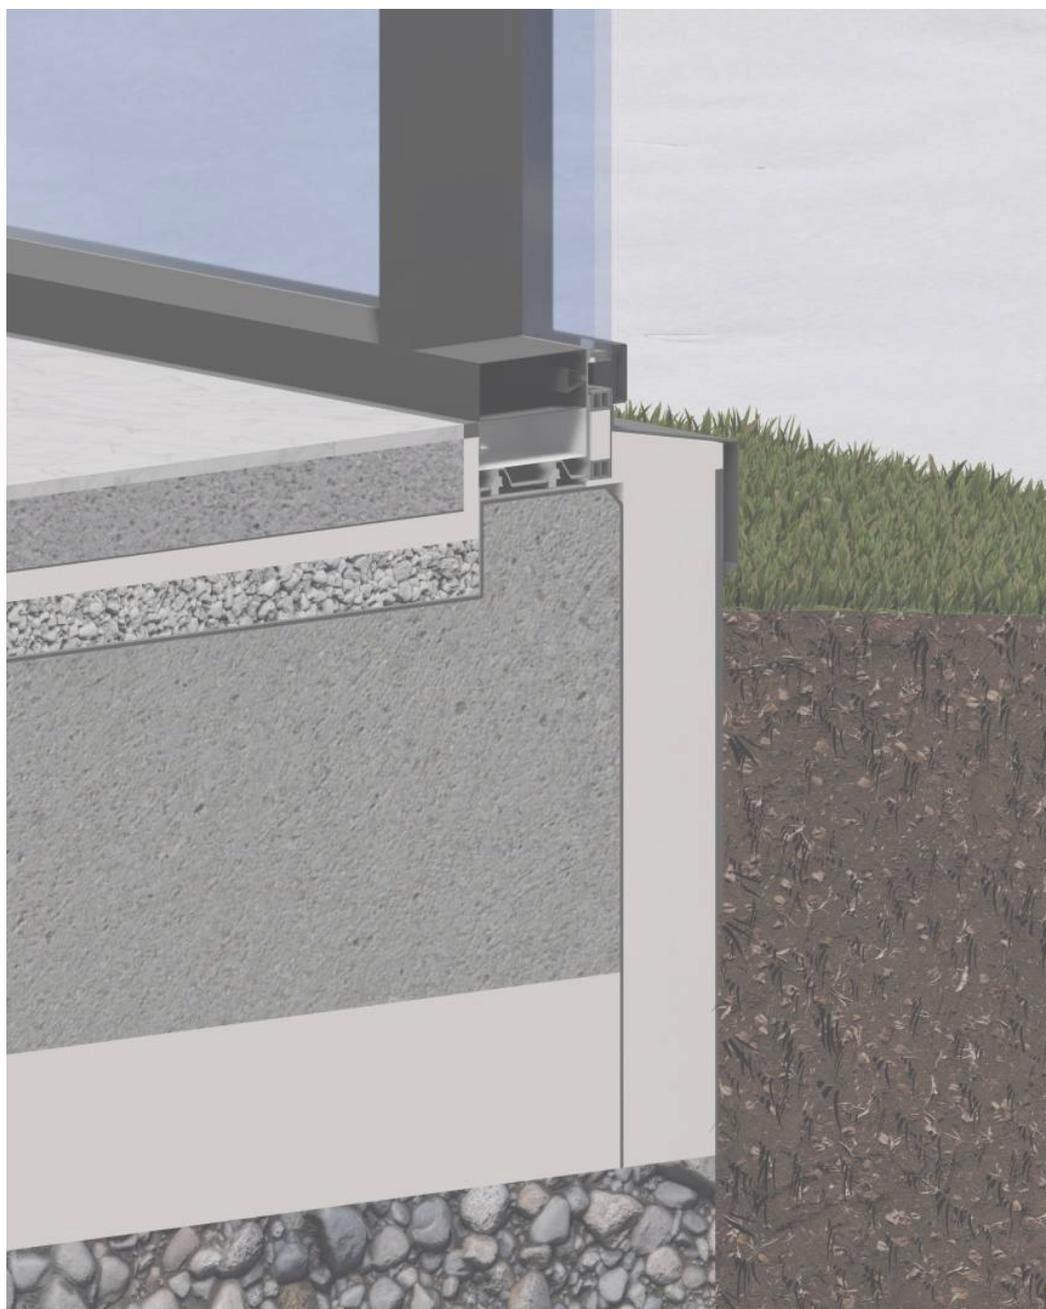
Detail Pfosten-Riegel-Fassade und Fundament Axonometrie
